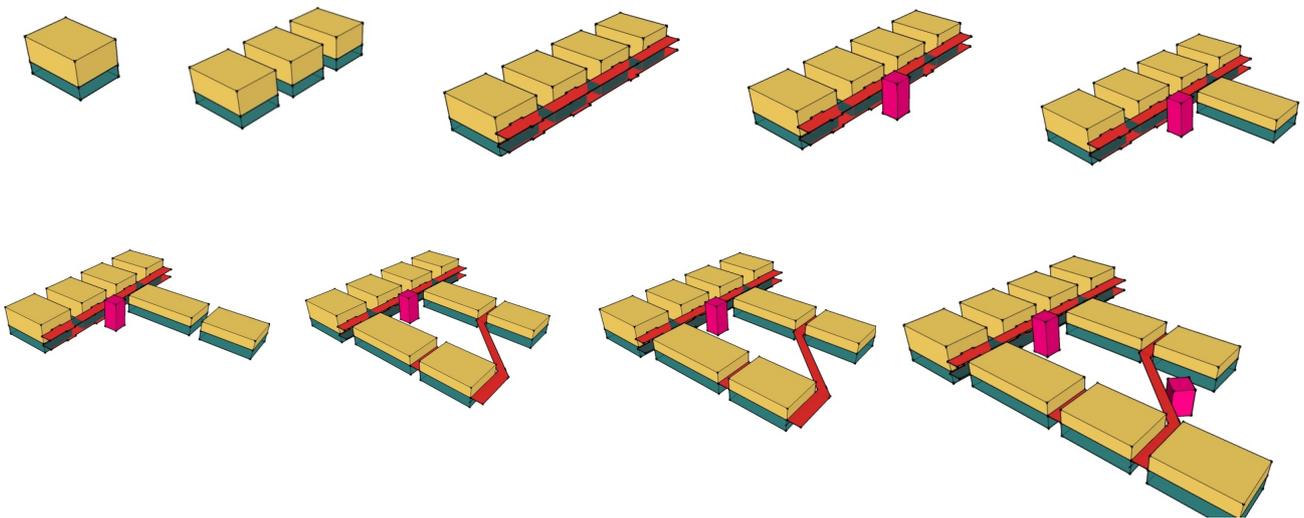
Etapas de Construção. Fonte: Barros (2016).
